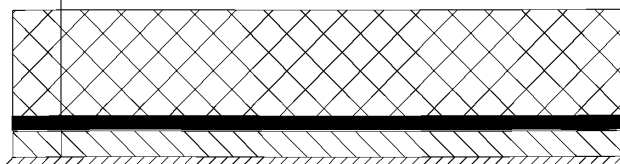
Дорожная одежда с применением литого полимерасфальтобетона на железобетонной плите проезжей части моста
